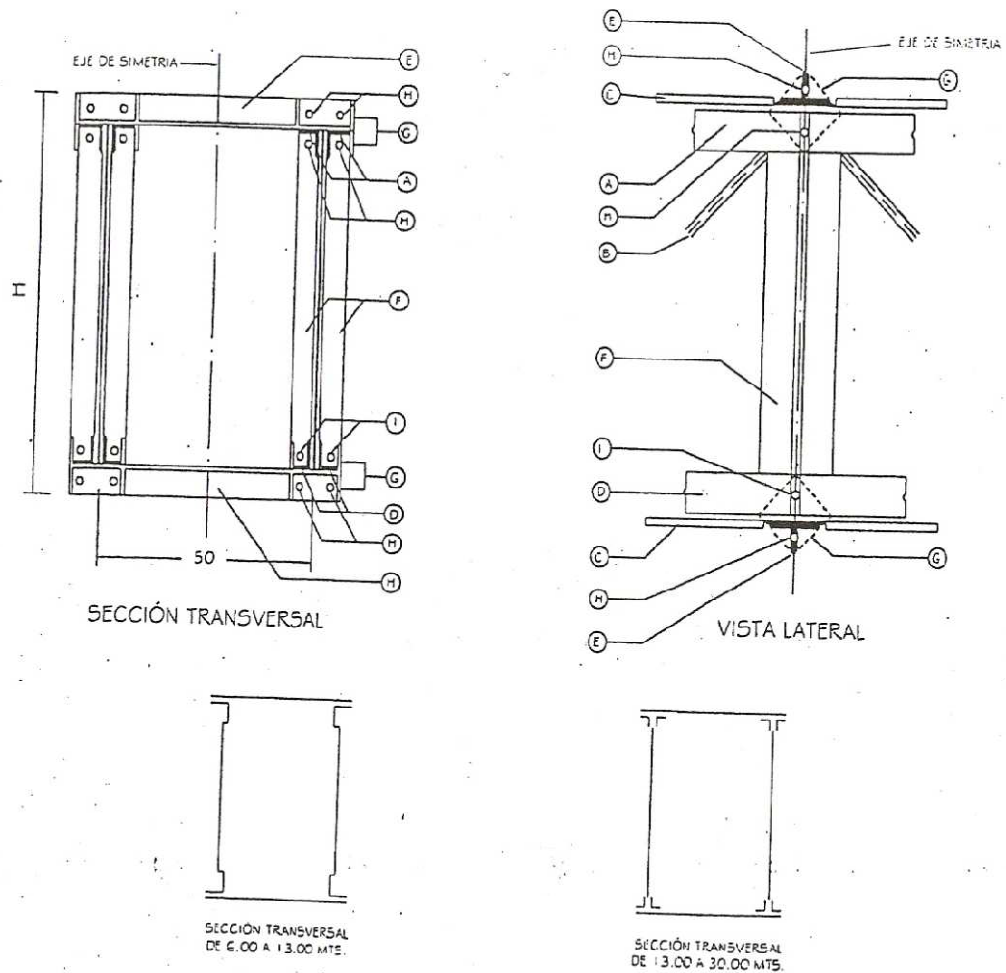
Detalles de Unión de los tramos en la Cercha Metálica, Imagen extraída Diseño de Cerchas de ETB.
